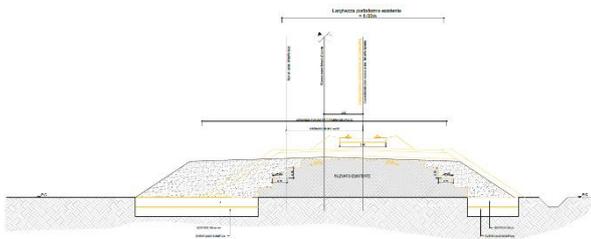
Fase 1: demolizione binario esistente e allargamento del rilevato
